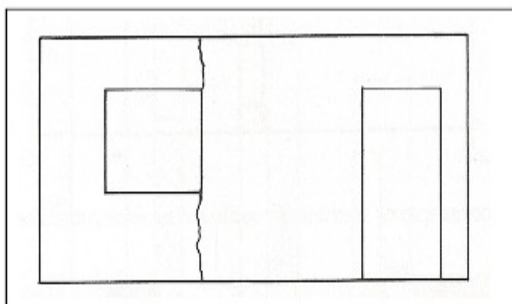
Fissuras de retração em paredes de concreto na seção enfraquecida pela presença do vão de janela
